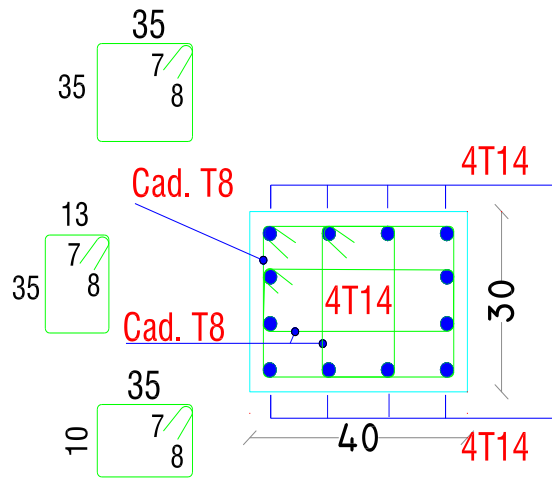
Ferraillage des poteaux (40×30) cm<sup>2</sup>.
